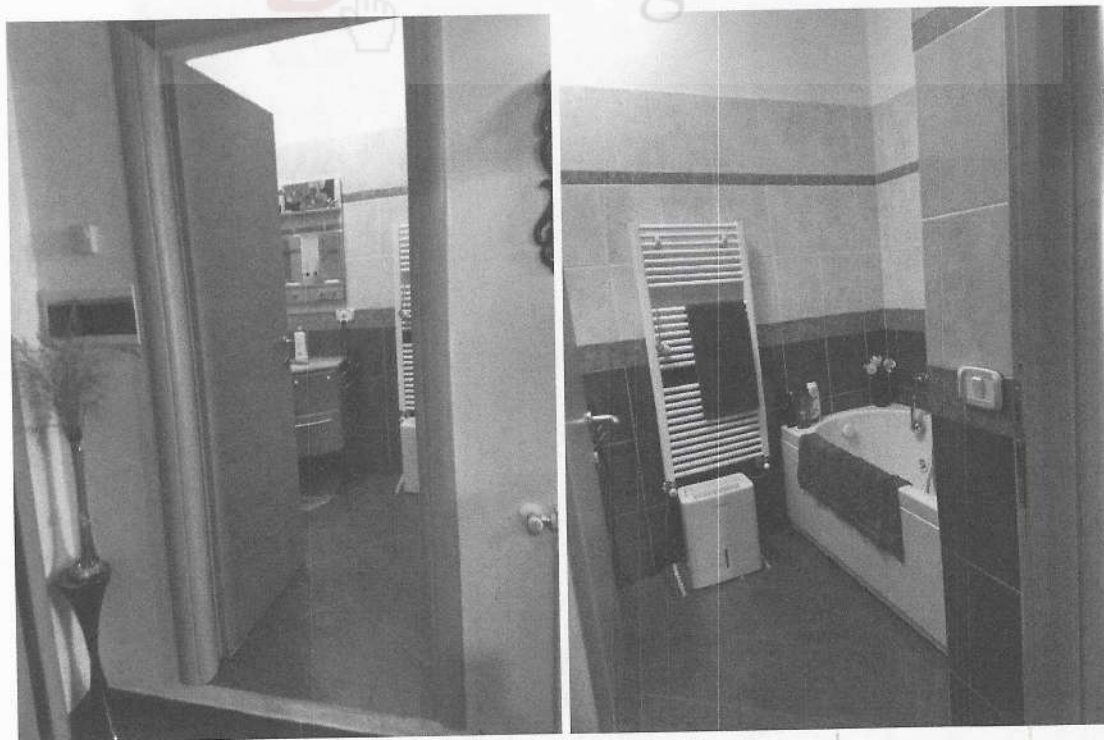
e 19. Vista parziale del bagno principale, al quale si accede dall'ingresso
